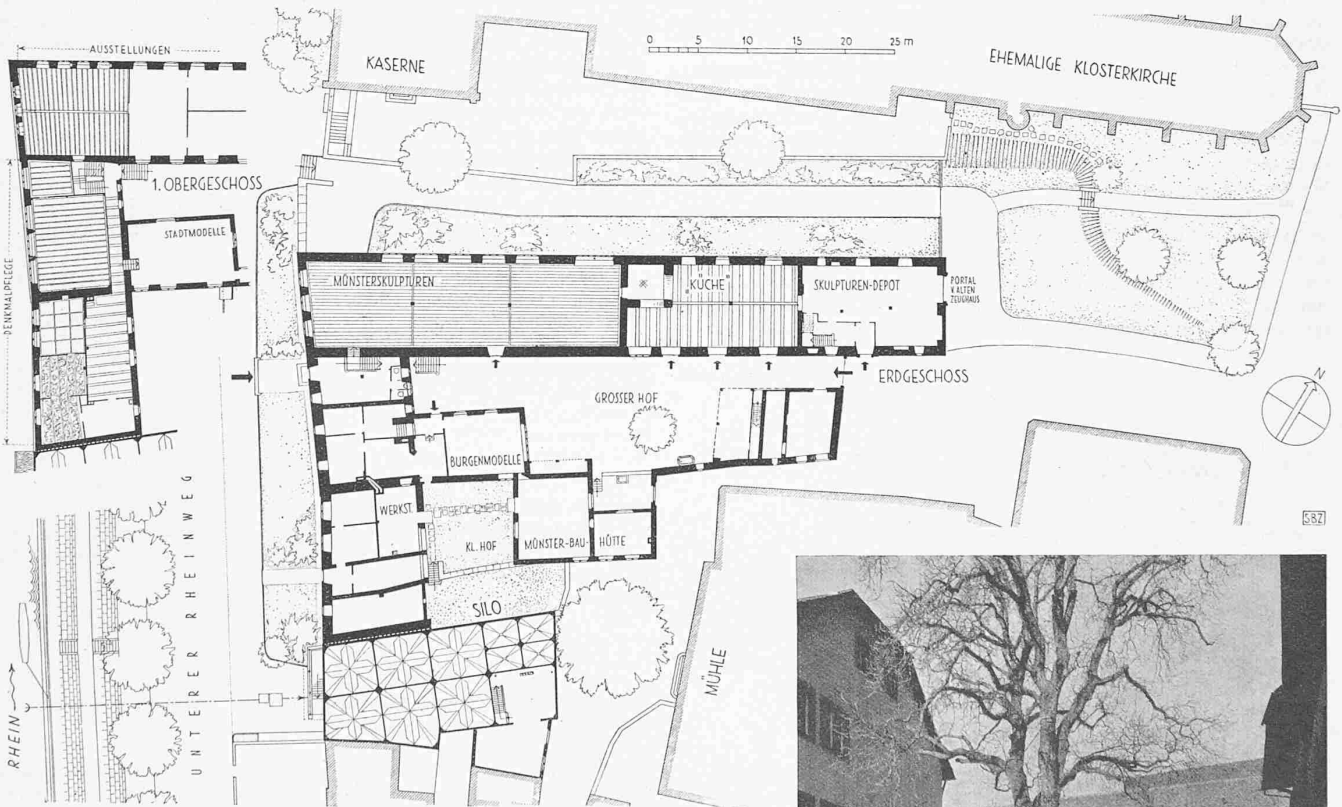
Grundrisse vom Kleinen Klingental, mit angebautem Silo. — 1:700
